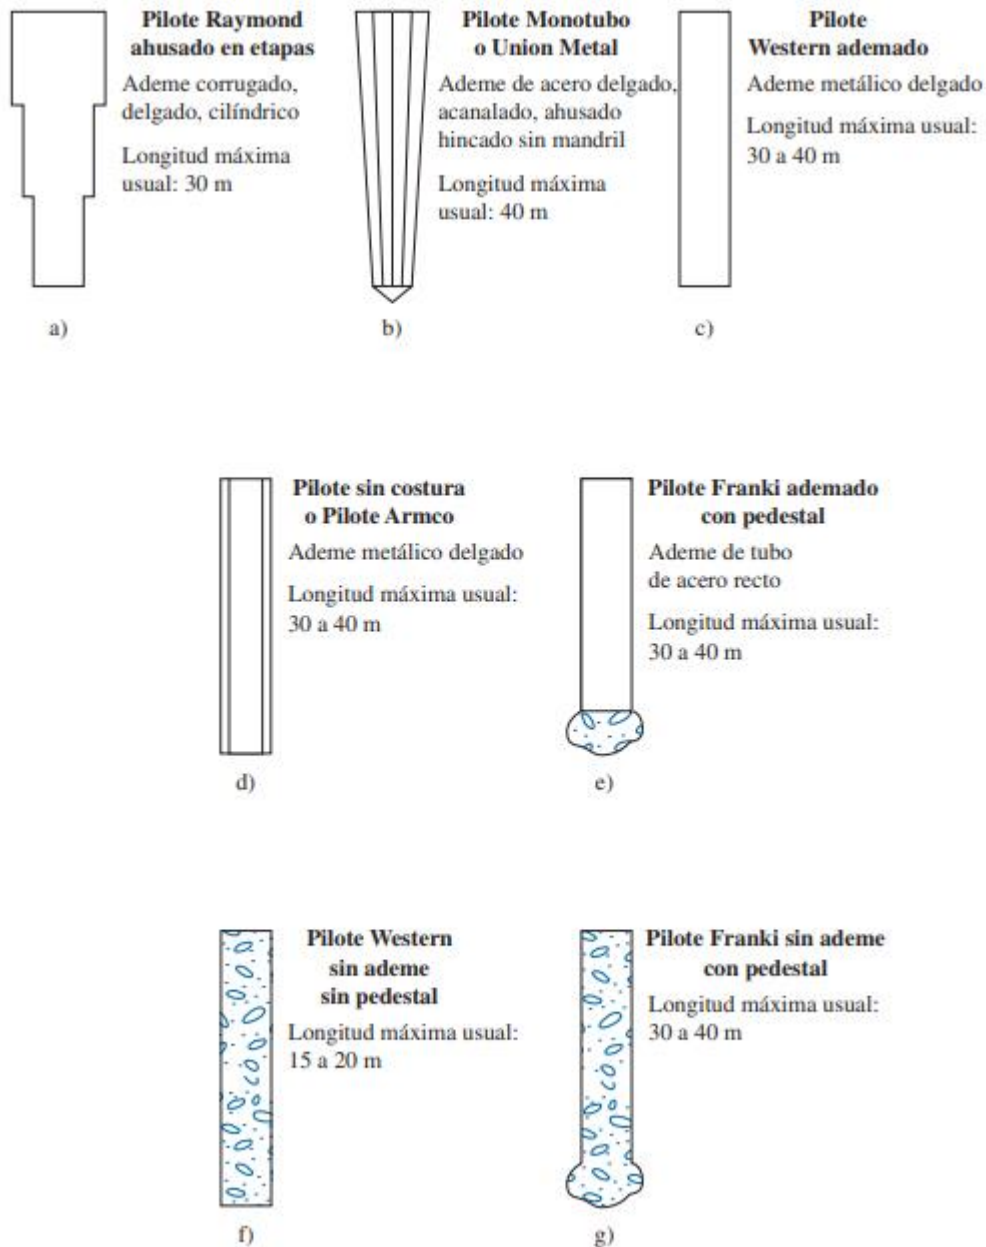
Tipos de pilotes de concreto colados in situ con ademe y sin ademe.
